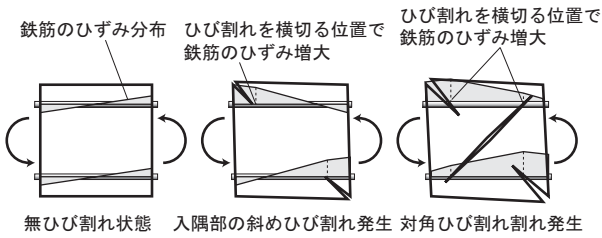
接合部のひび割れと鉄筋のひずみ
